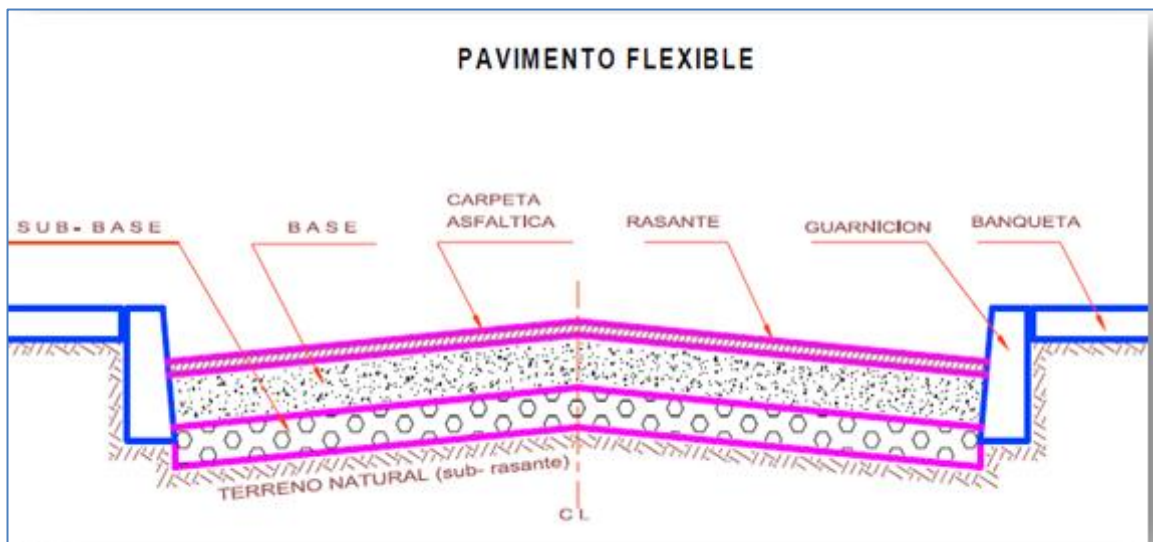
Corte esquemático con cada una de las partes de un pavimento flexible
